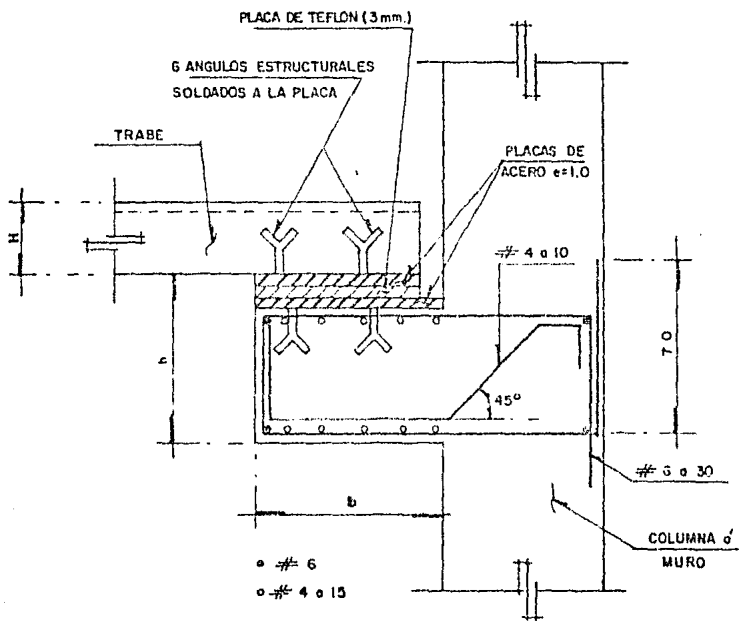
MENSULAS ; DETALLE TIPICO
